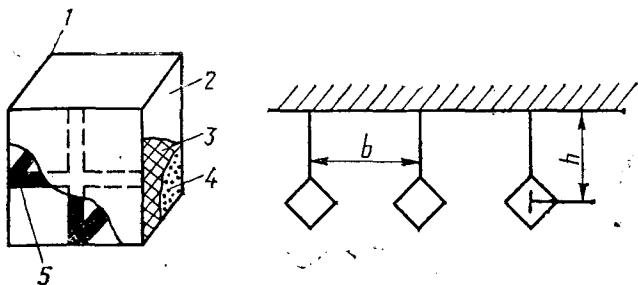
Конструкция и схема размещения штучных поглотителей: 1 — точка подвеса; 2 — поверхность; 3 — оболочка; 4 — звукопоглотитель; 5 — каркас
